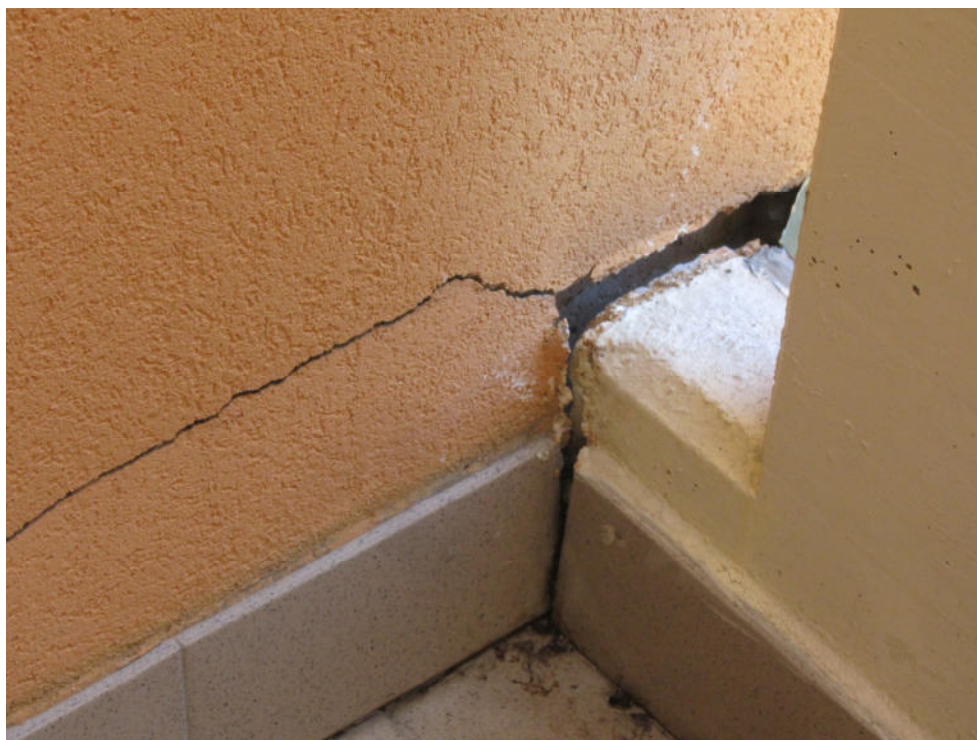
PIANO PRIMO_particolare distacco balcone 2
